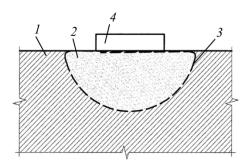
Песчаная подушка в геосинтетической оболочке: 1 – грунт основания; 2 – песок; 3 – геотекстиль; 4 – фундамент Fig. 5. The sand cushion in the geosynthetic shell: 1 – foundation soil; 2 – sand; 3 – geotextile; 4 – foundation
